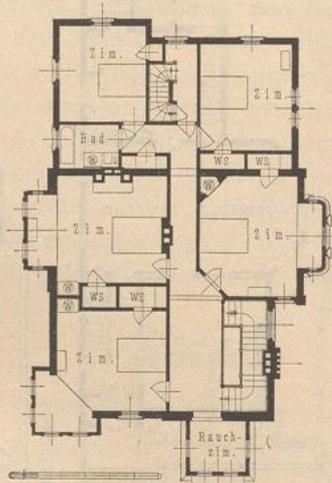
u. 254<sup>236</sup>) zeigen den Grundriss vom Erdgeschoss und Obergeschoss eines Wohnhauses zu New-Haven (Arch.:
